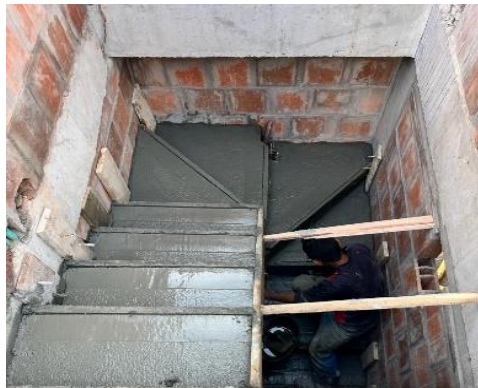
, Fundida escalera individual, Fuente: Autoría propia.
